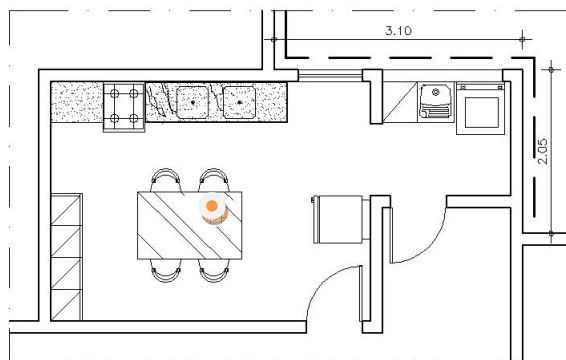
Edifício Branco: Planta baixa da cozinha / área de serviço.
